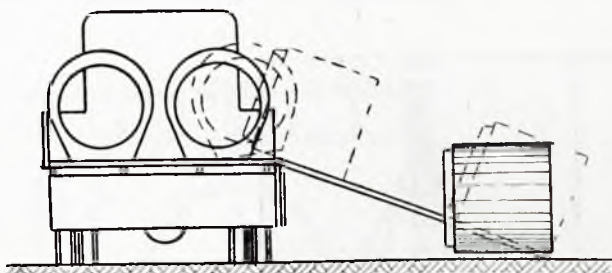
Kanał na palach drewnianych zabetonowanych w płycie
